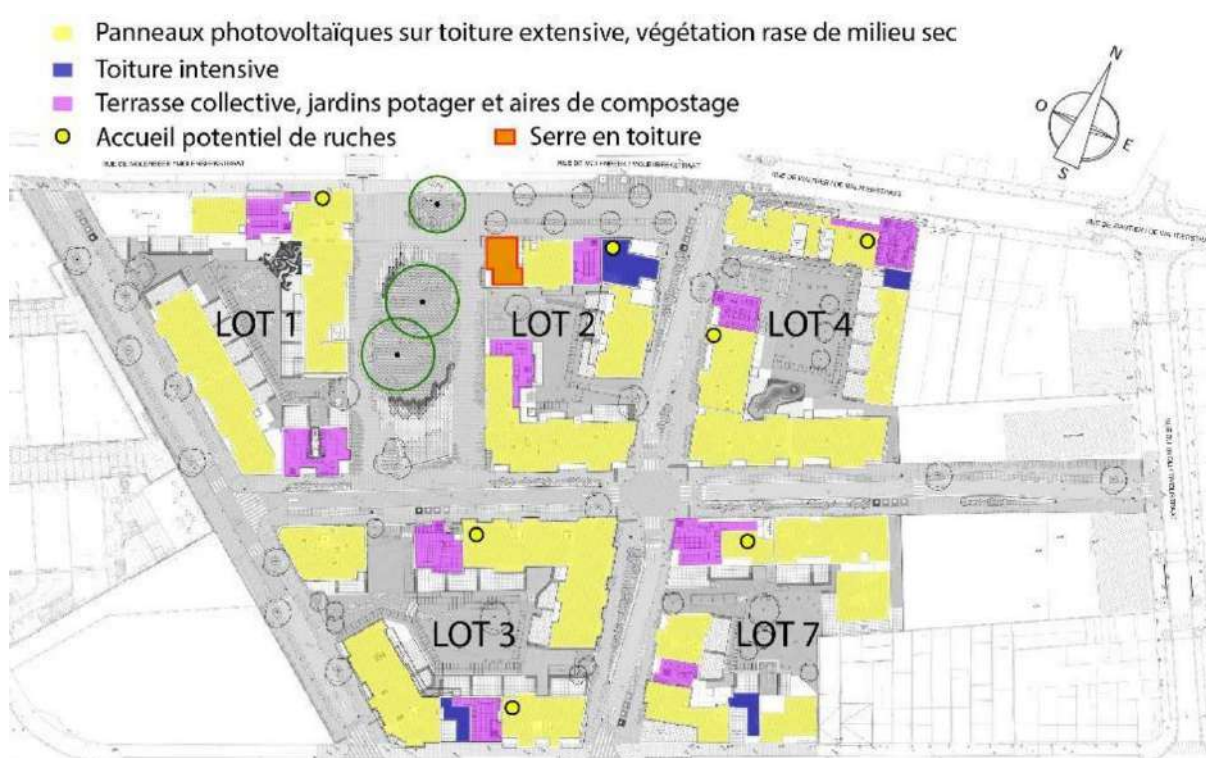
Plan d'occupation de toiture (Séminaire Bâtiment Durable : Bâti et biodiversité)
